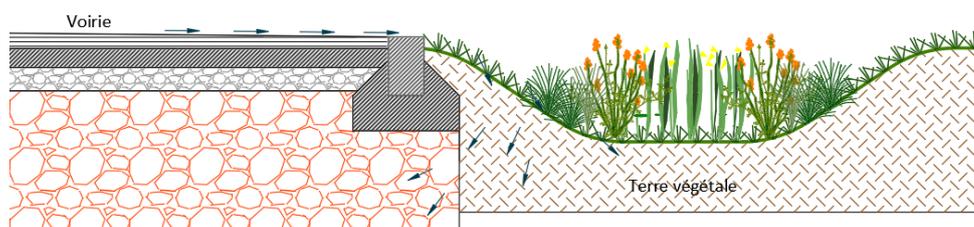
Exemple d'une coupe d'une chaussée réservoir avec injection par jardin de pluie (INFRA Services)
